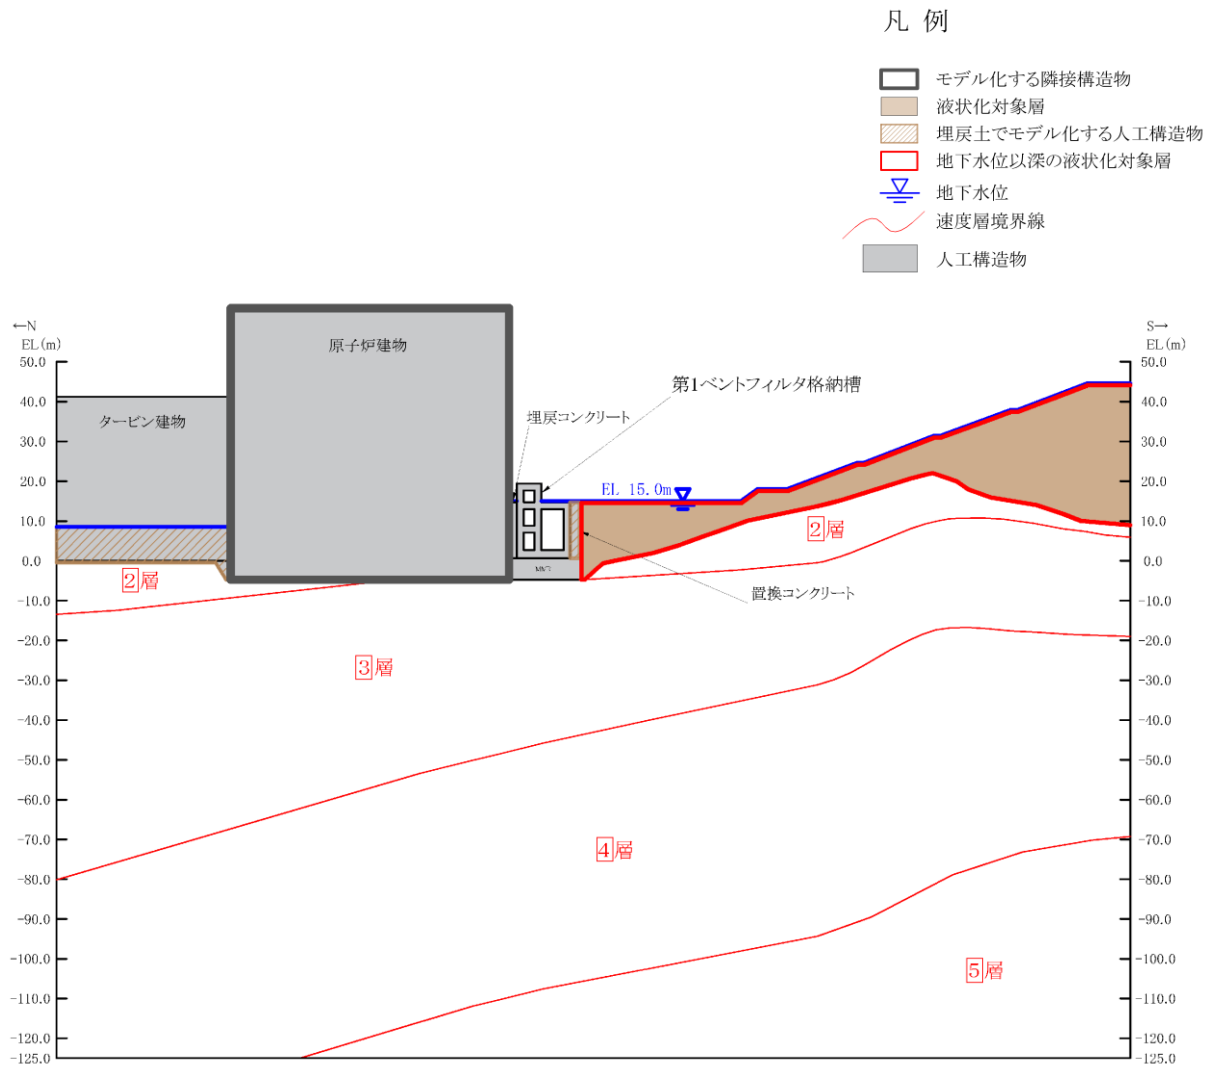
第 1 ベントフィルタ格納槽 評価対象断面図 (A-A 断面位置)
